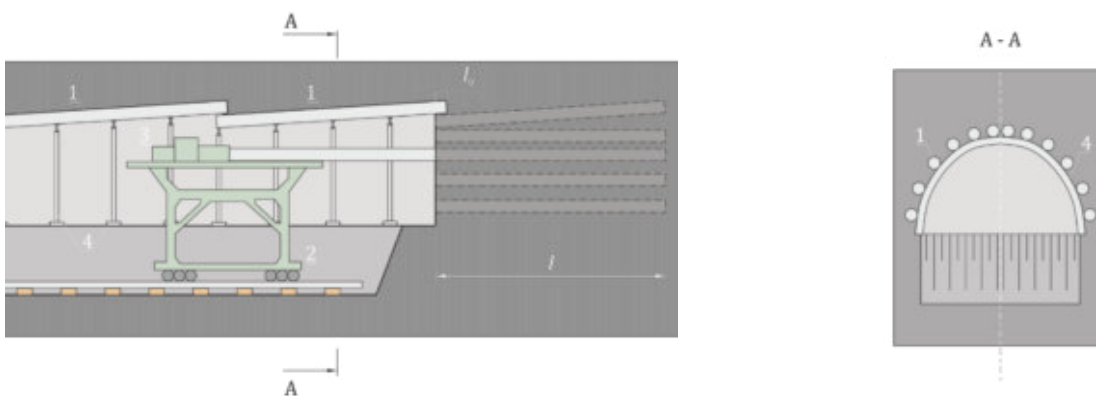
Схема устройства экрана из труб из забоя выработки:
